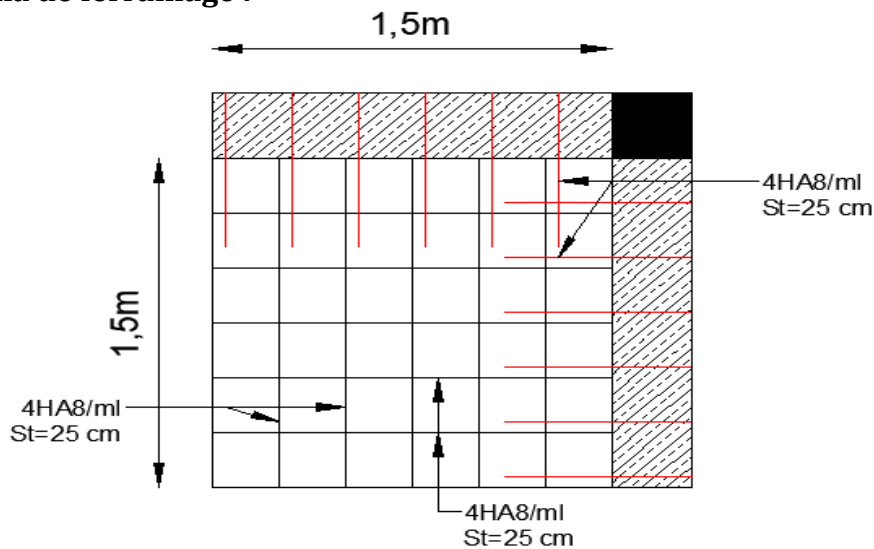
schéma de ferrailage des dalles sur 2 appuis.
